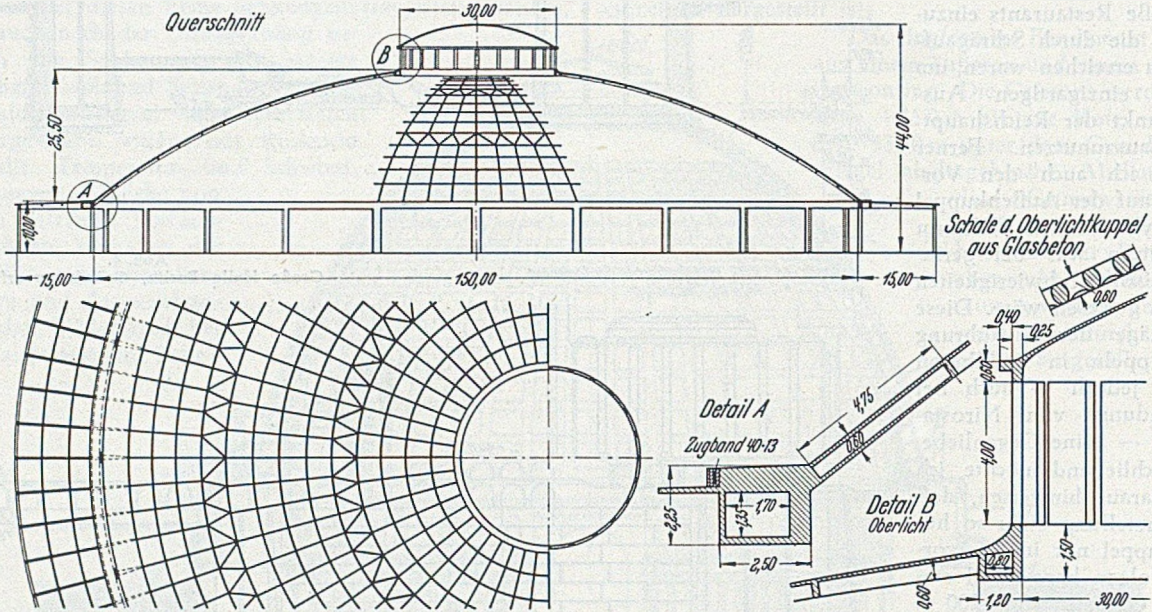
Querschnitt und Grundriß einer 150 m weit gespannten Schalenkuppel.
